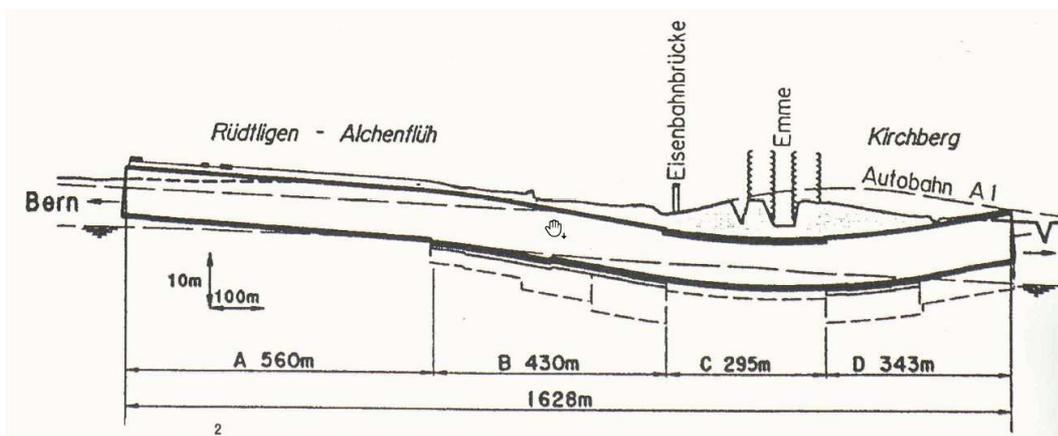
Sezione tunnel Emmequerung nella zona del sottoattraversamento del fiume Emme e dell'autostrada A1 (Menètrety et al., 2001).
